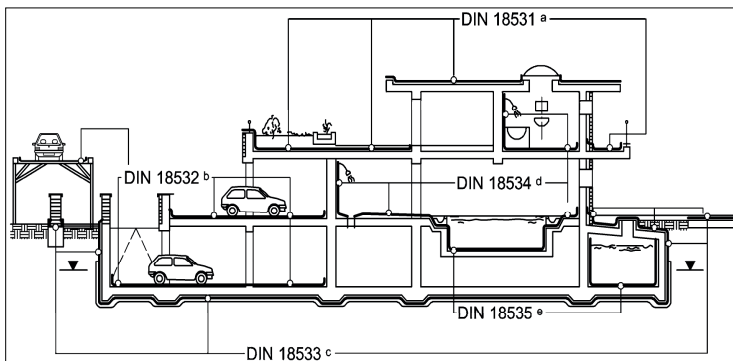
Übersicht zu den Anwendungsbereichen der Normen für die Abdichtung von Bauwerken [1]
